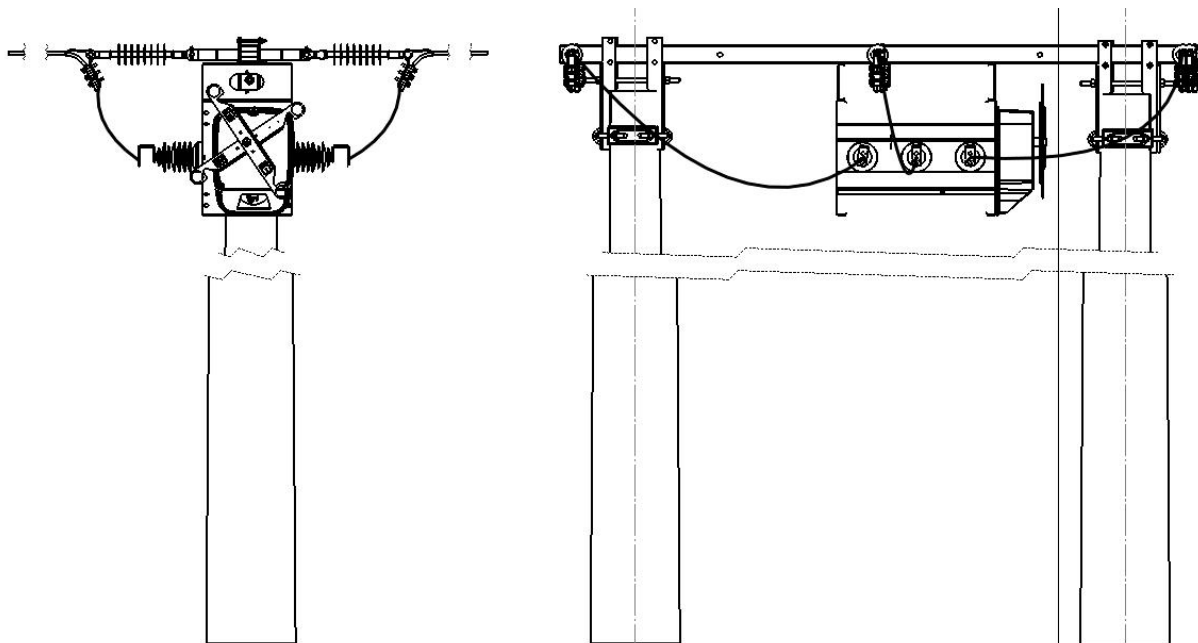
Montaż NXA na 2 słupach okrągłych betonowych, poniżej poprzeczki, działanie ręczne dźwężkiem.
